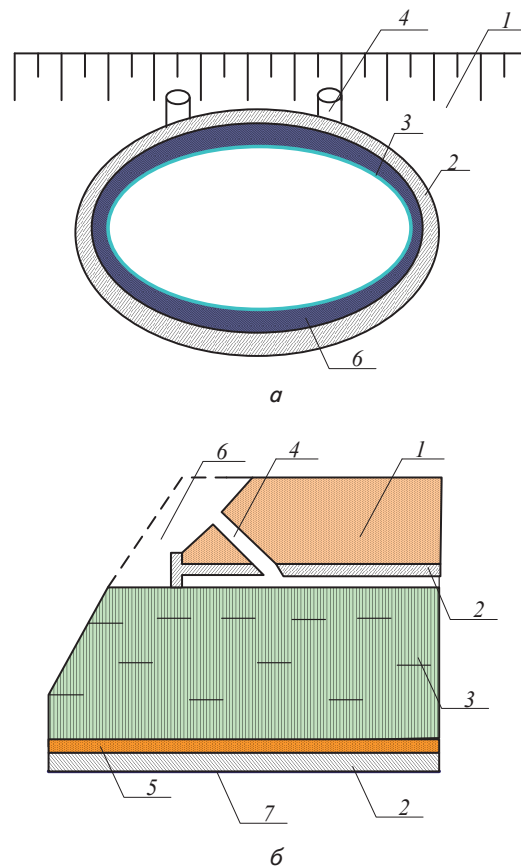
Отвори для подачі бетону, розміщені у насипі: а – вид з торця подачі бетону; б – поздовжній переріз, об'єкту; 1 – насип; 2 – об'єкт, який ремонтується; 3 – конструкція з гофрованого металу; 4 – отвори для подачі бетону, або оглядові; 5 – подушка з піску, або гравію із розширення насипу; 6 – опалубка, геотекстиль, або геосітка
